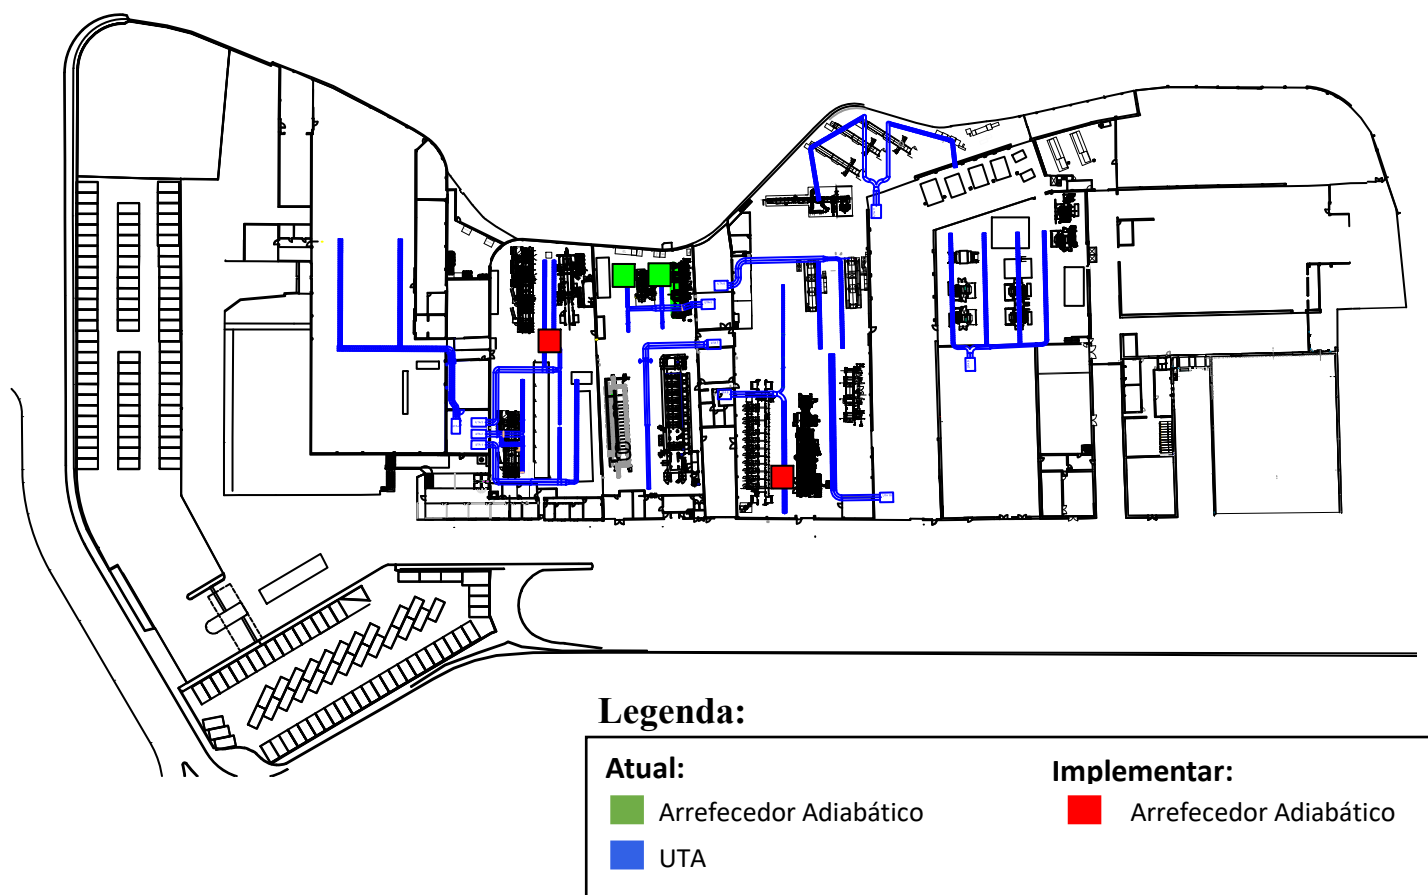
Planta com proposta de implementação de AA para melhoria do sistema de ventilação
